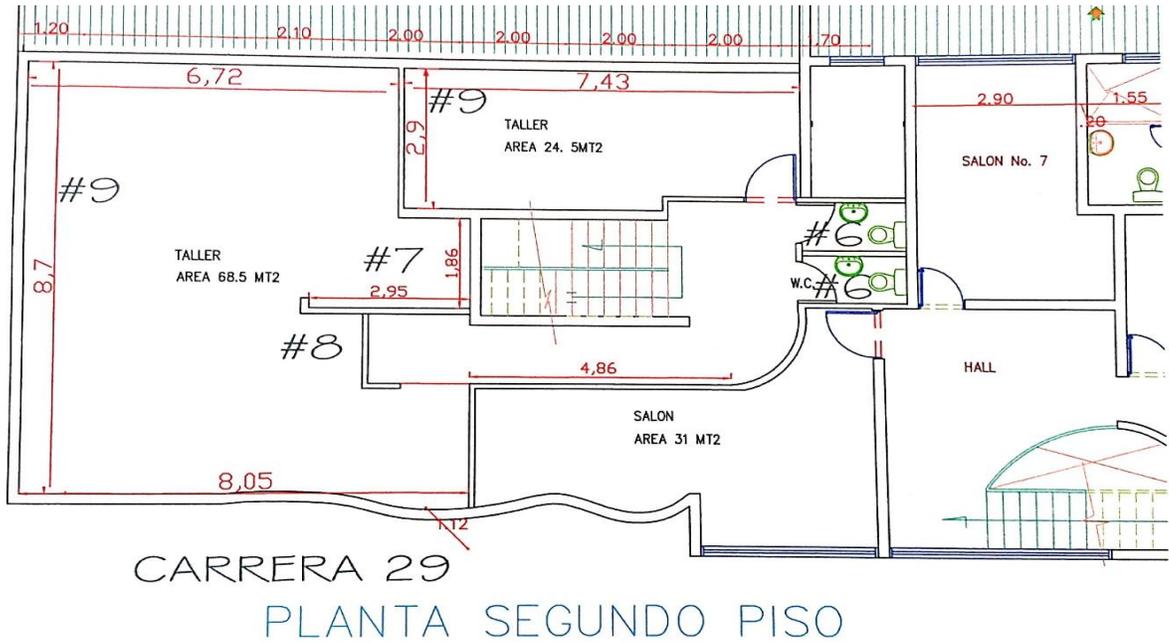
Plano arquitectónico segundo nivel sede I.T.L.S.
